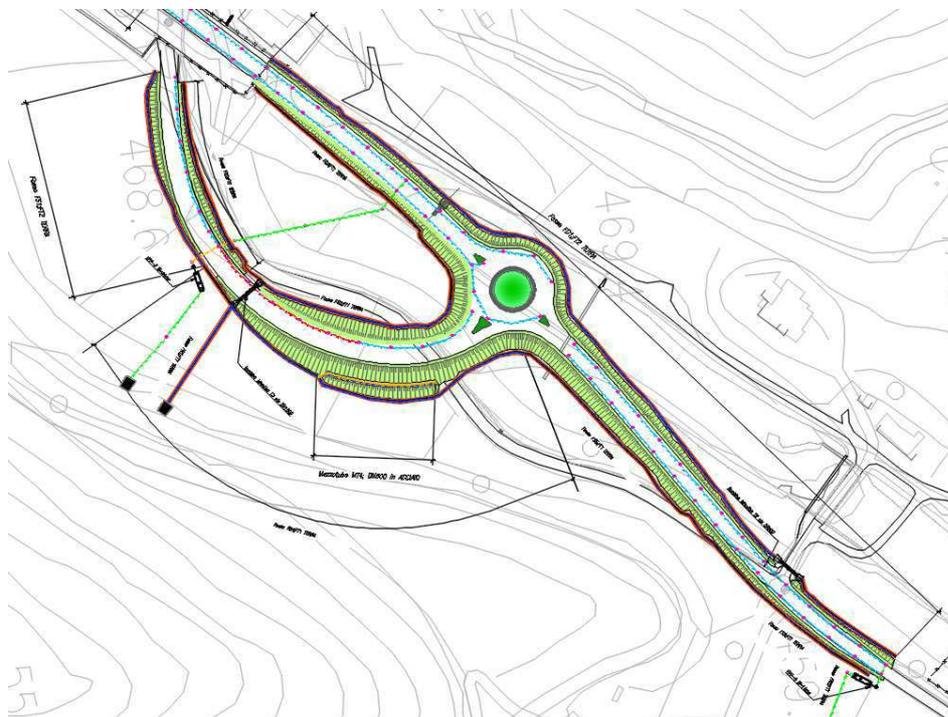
planimetria Idraulica dell'intersezione Lato Marche
